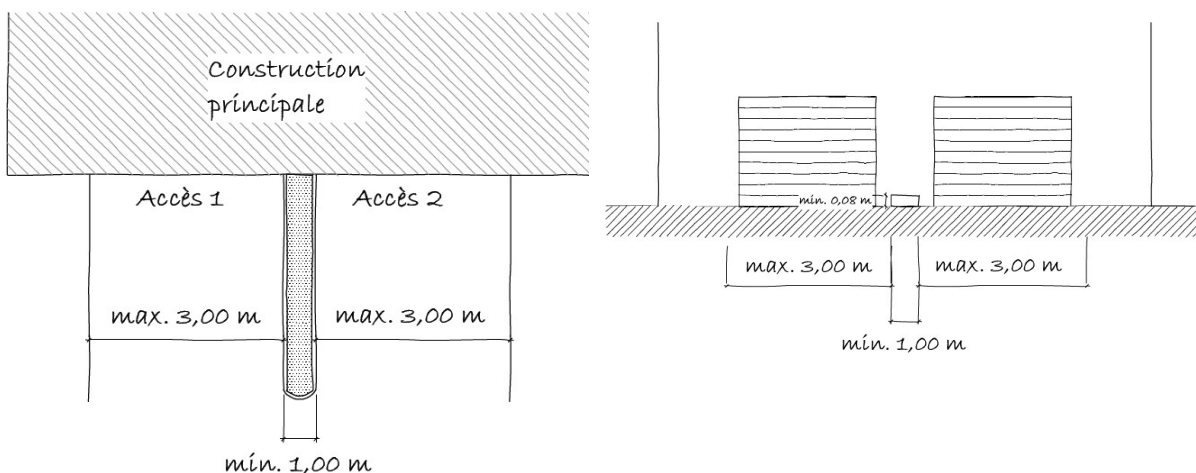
séparation de deux accès placés côte à côte - vues en plan et en coupe
